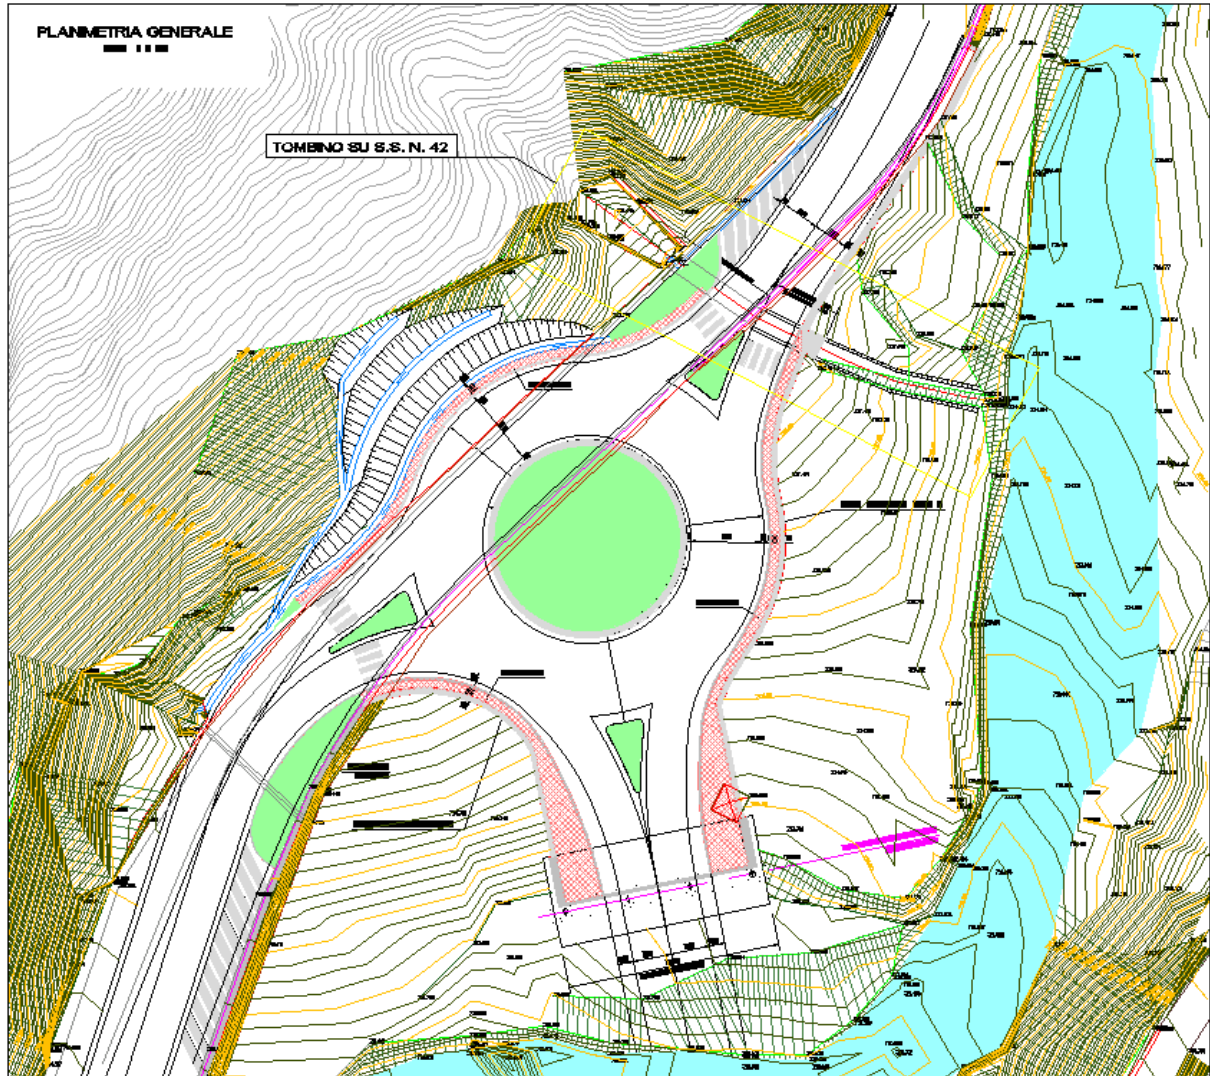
Schema planimetrico Rotatoria Sud -
